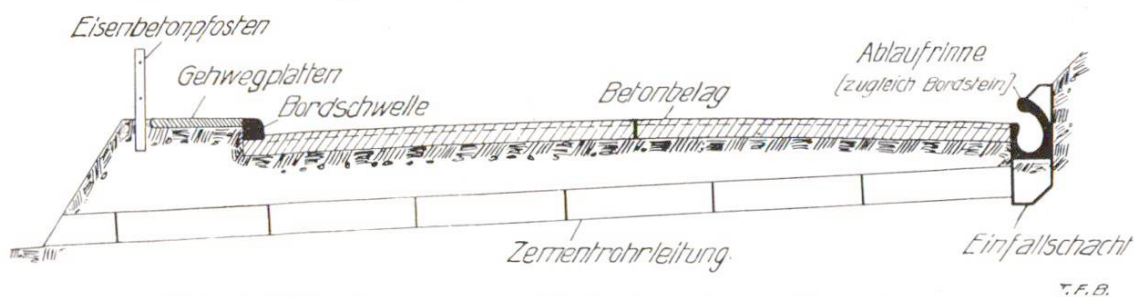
Betonstrasse, ausgerüstet mit modernen Cementwaren
